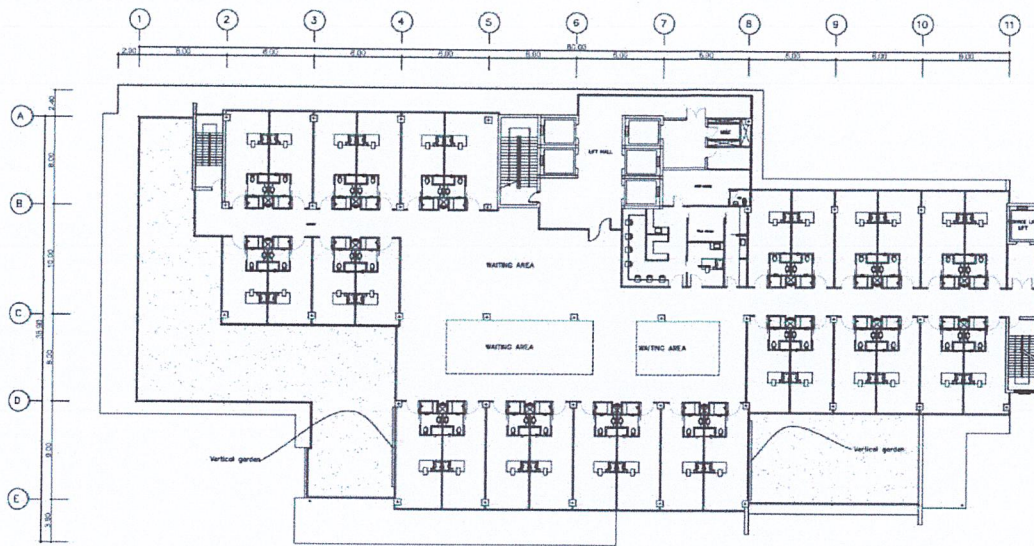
2<sup>nd</sup> Floor Plan
